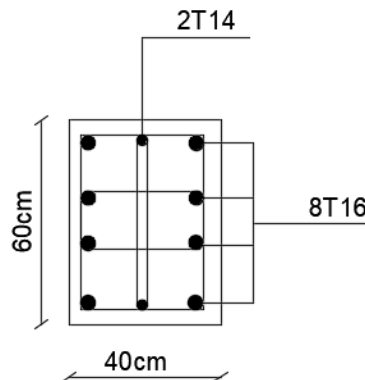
Schéma de ferrailage du poteau (40×60)
